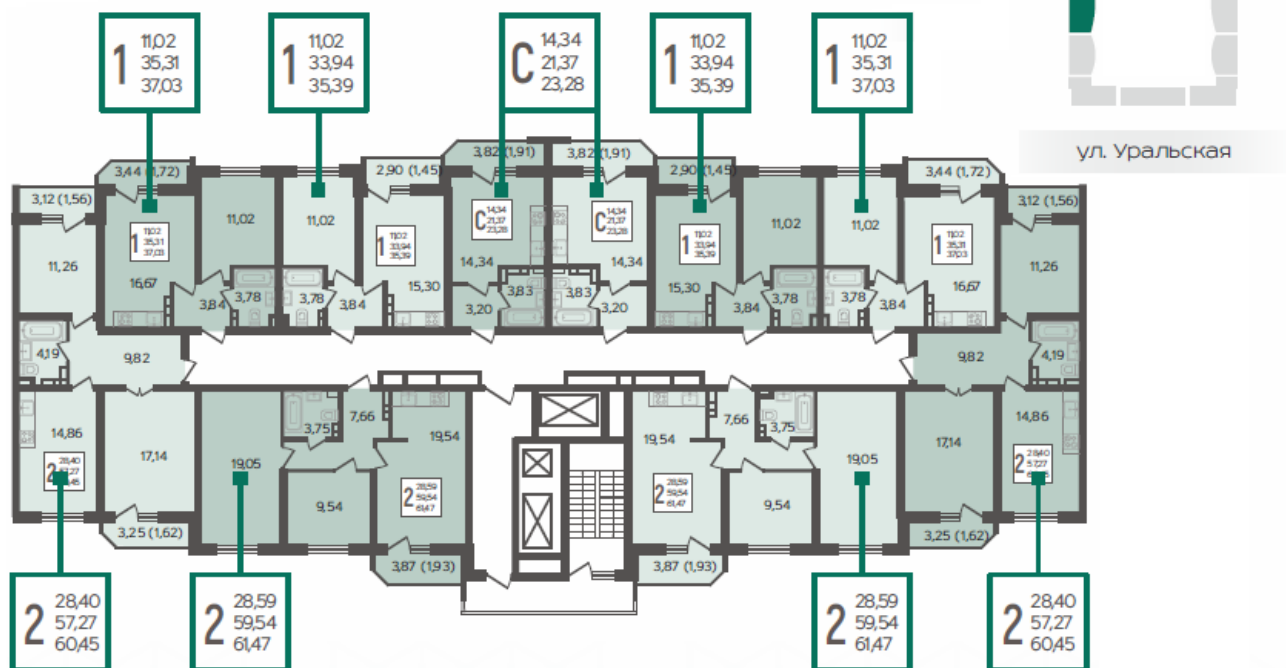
Типовой план 8-13 этажа БС-3 ЖК URAL
